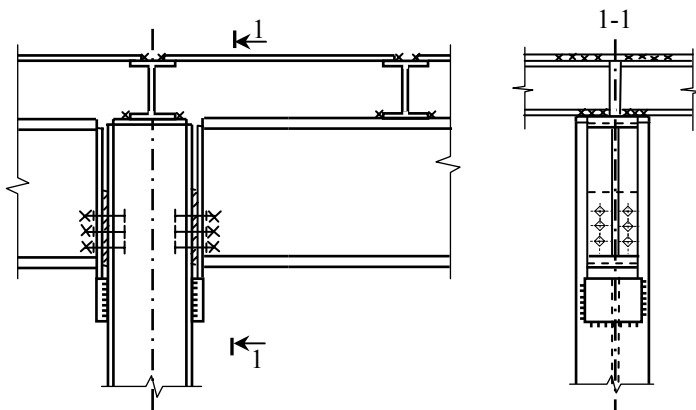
Оголовок сплошной колонны при опирании главной балки на колонну сверху
